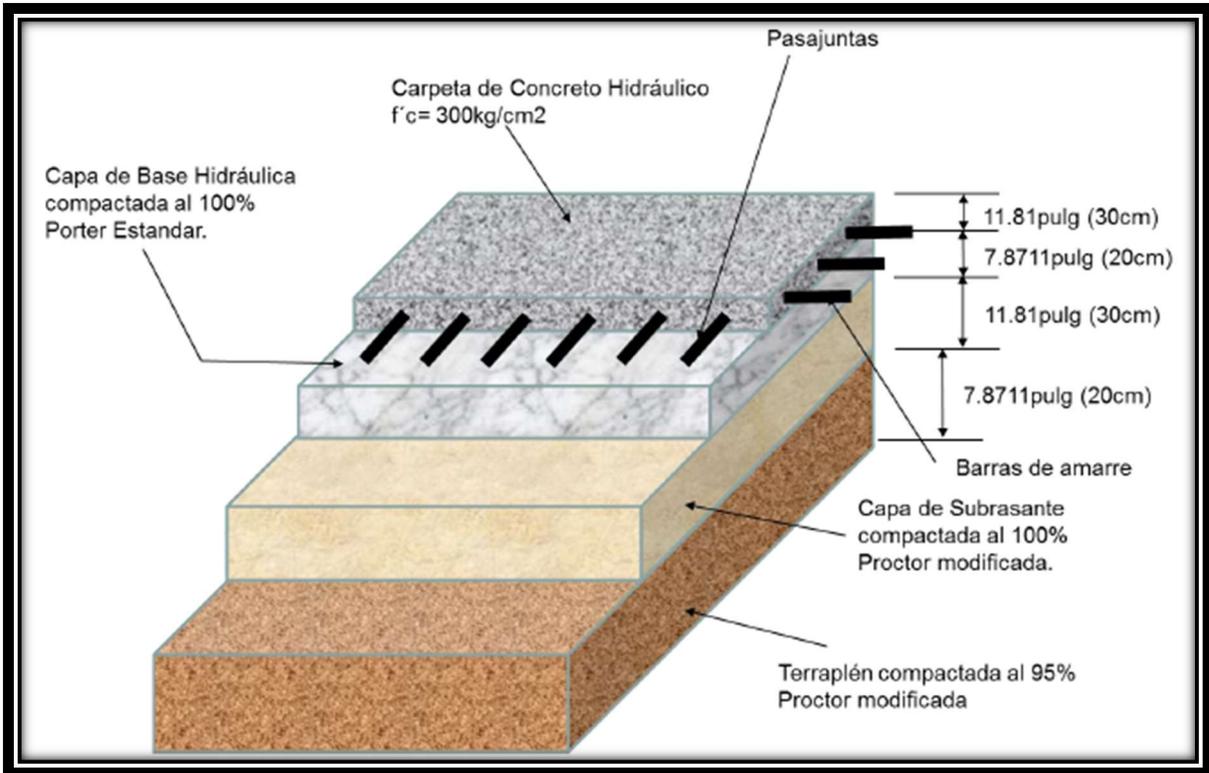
Sección de Pavimento rígido para carretera estatal No. 431, del km 0+000 al k 2+800. Fuente: Informe de pavimento CEI.
